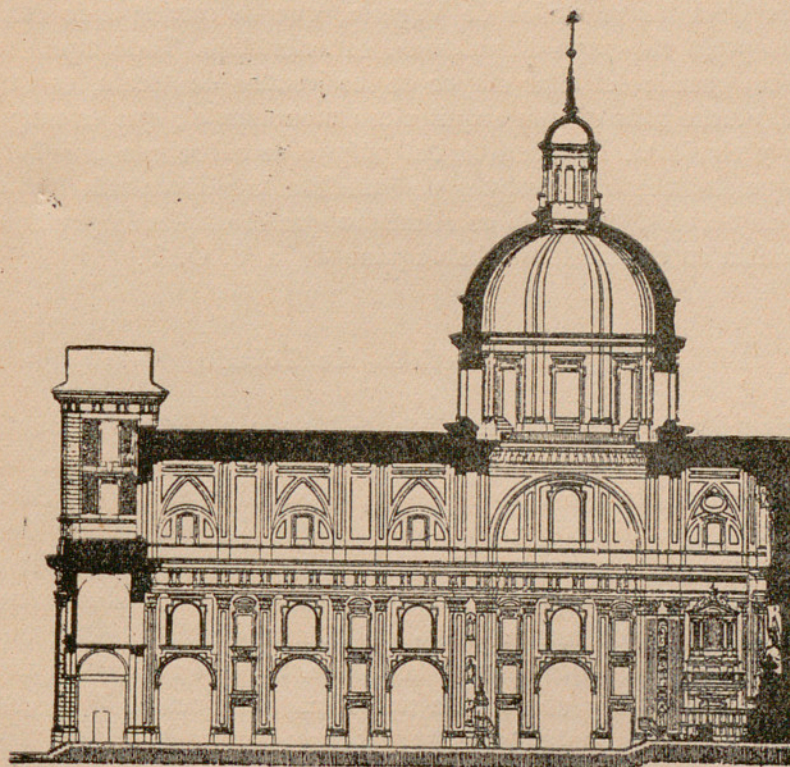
Alzado de la Catedral de Madrid. (O. Schubert.)
